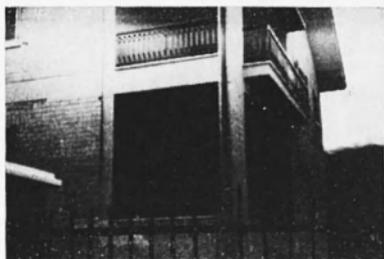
Norcia, distacco di tamponature da una struttura in cemento armato.
